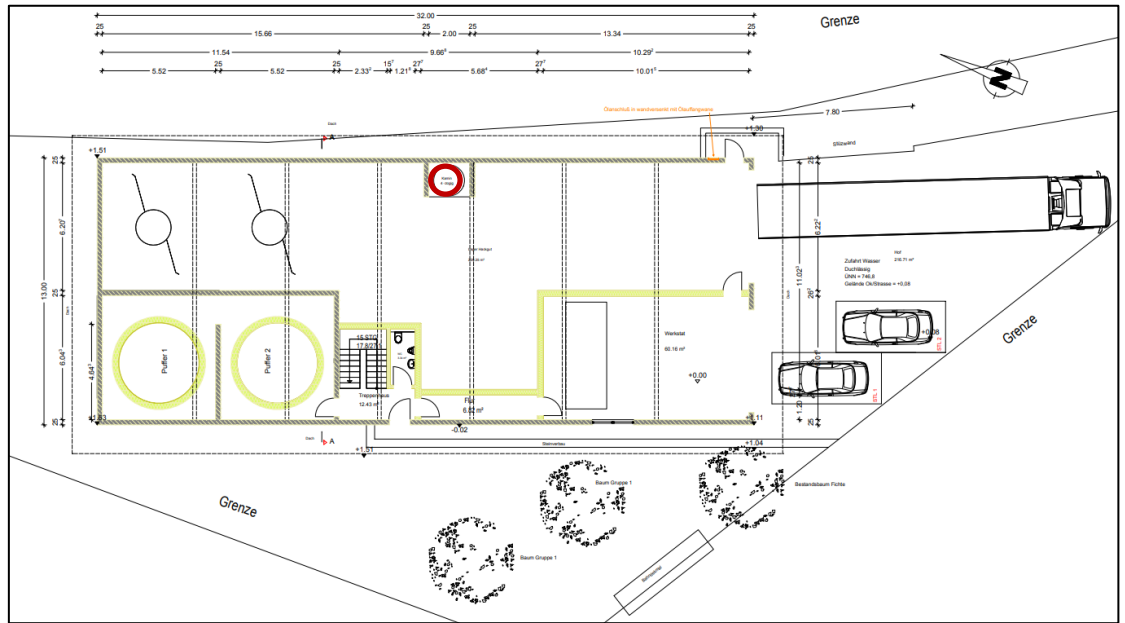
Vorläufiger Grundrissplan des Heizgebäudes (Erdgeschoss), der geplante Kamin ist rot umrandet [13].
